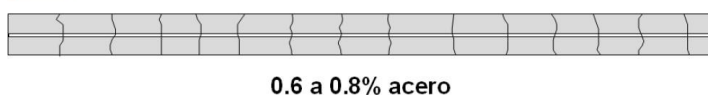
Pavimento de concreto continuamente reforzado. Fuente: M. Becerra Salas, Tópicos de Pavimentos de Concreto, Lima-Perú: Flujo libre, 2012
